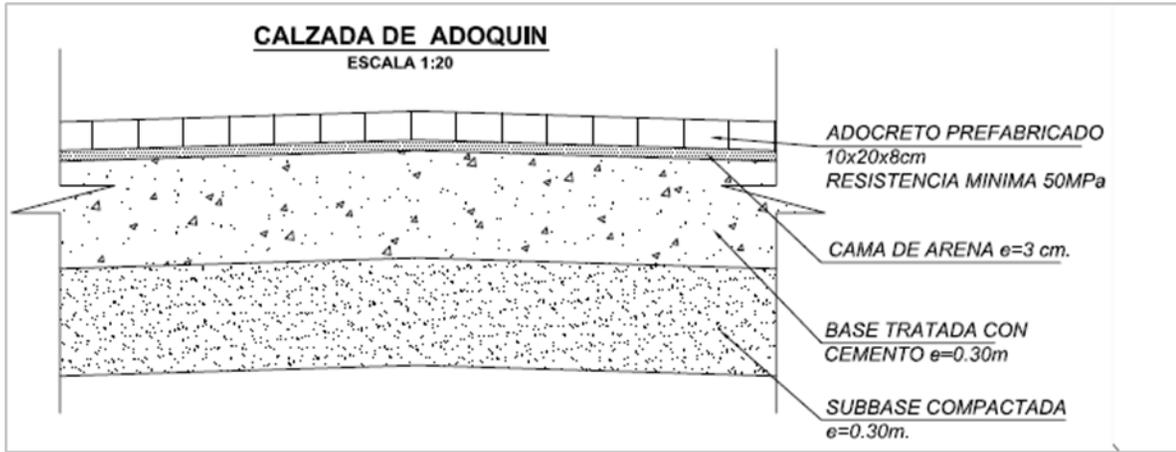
Detalle estructura de pavimentos de hormigón
